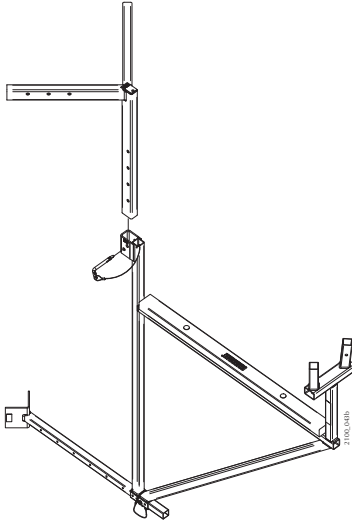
Montage der Eckplattformkonsole an Eckbefestigung oder Zwingenbefestigung
